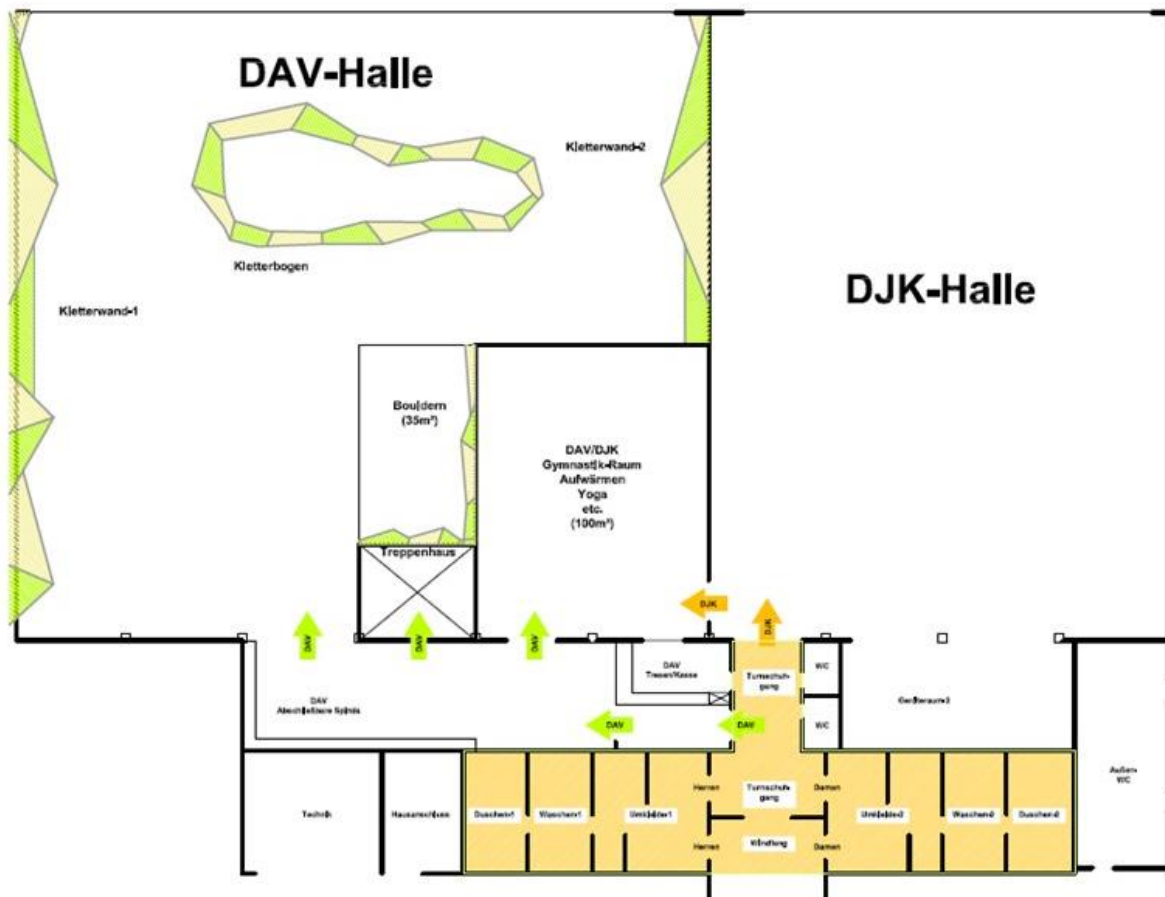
; DJK Halle, Bestand, Erdgeschoss
